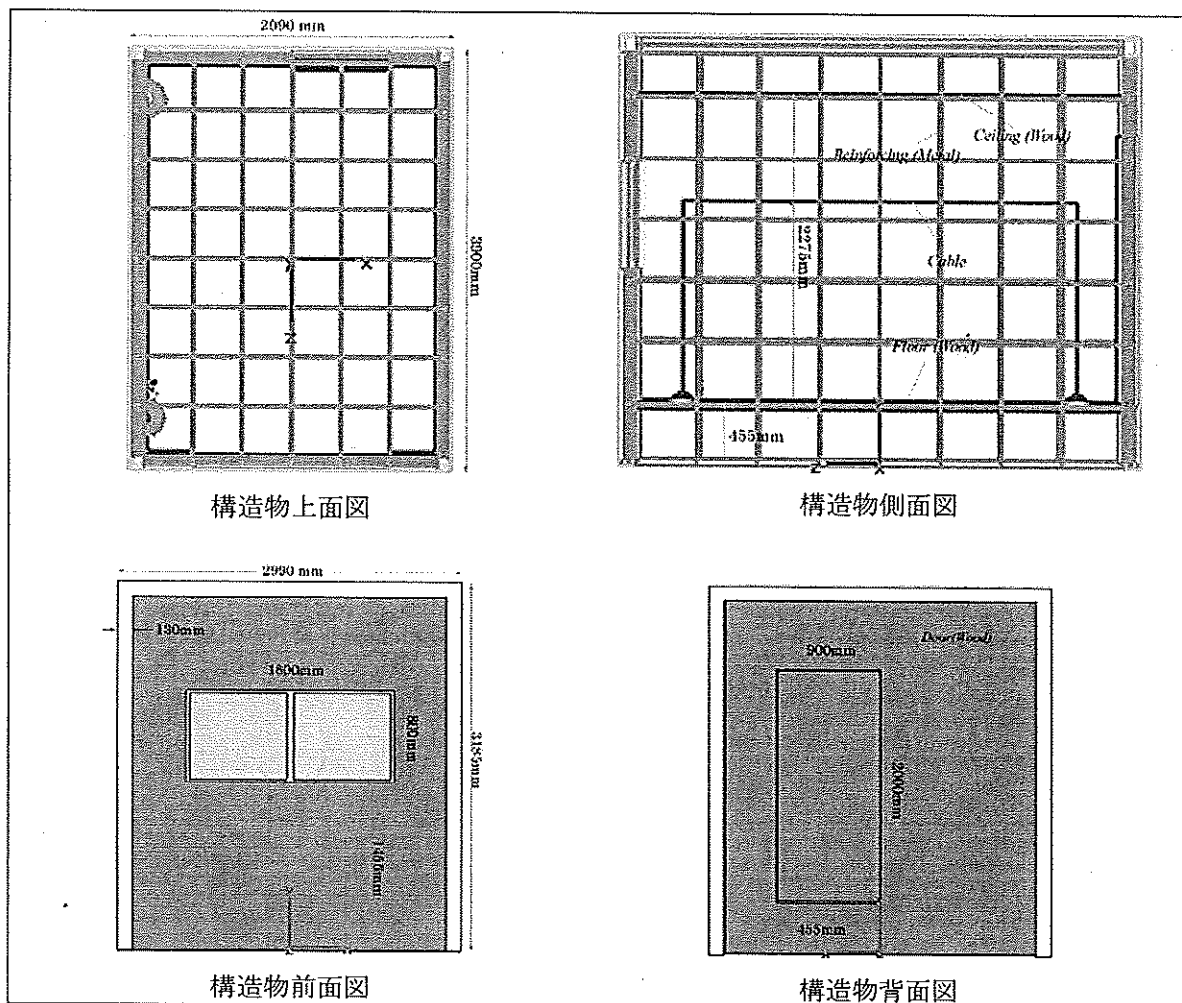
計算モデルの構造（鉄筋コンクリート構造物）
